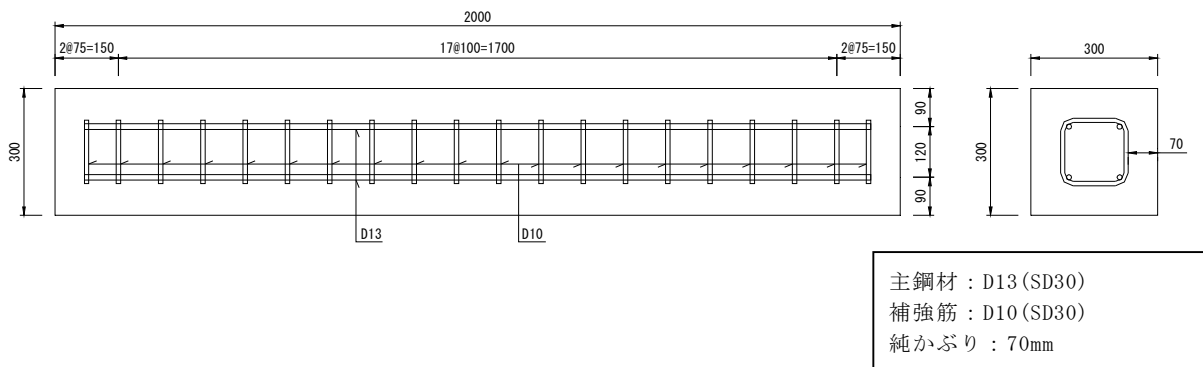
試験体形状（鉄筋コンクリート中型試験体）
